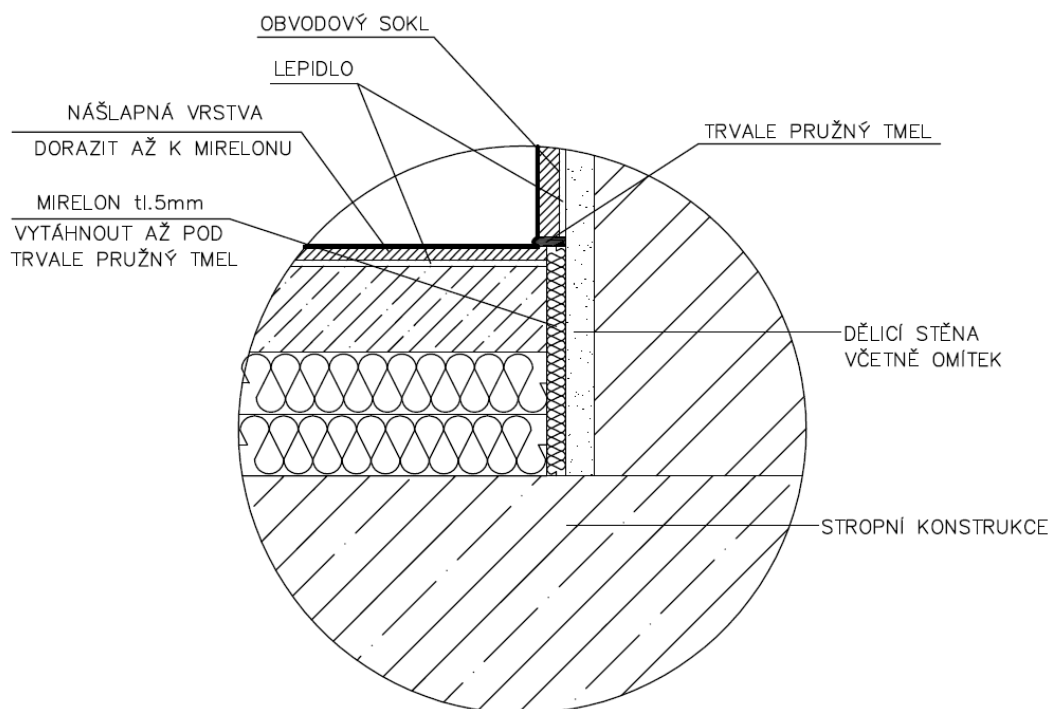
DETAIL PO PROVEDENÍ NÁŠLAPNÉ VRSTVY
